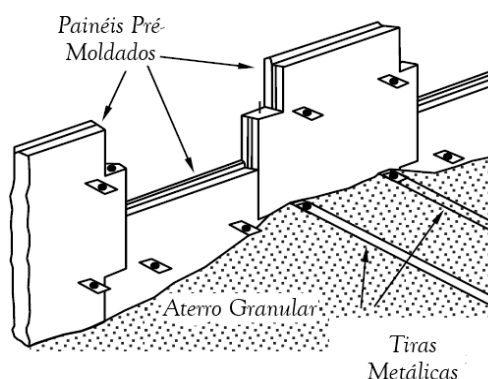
Muro de Solo Reforçado com Tiras Metálicas
